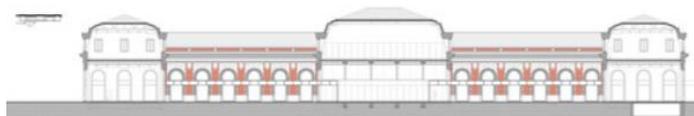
Corte Longitudinal da Estação de Burgos. A nova divisão de pavimentos segue relação com a fachada. Fonte: : Acervo site Archdaily. Acesso em Junho/2018
